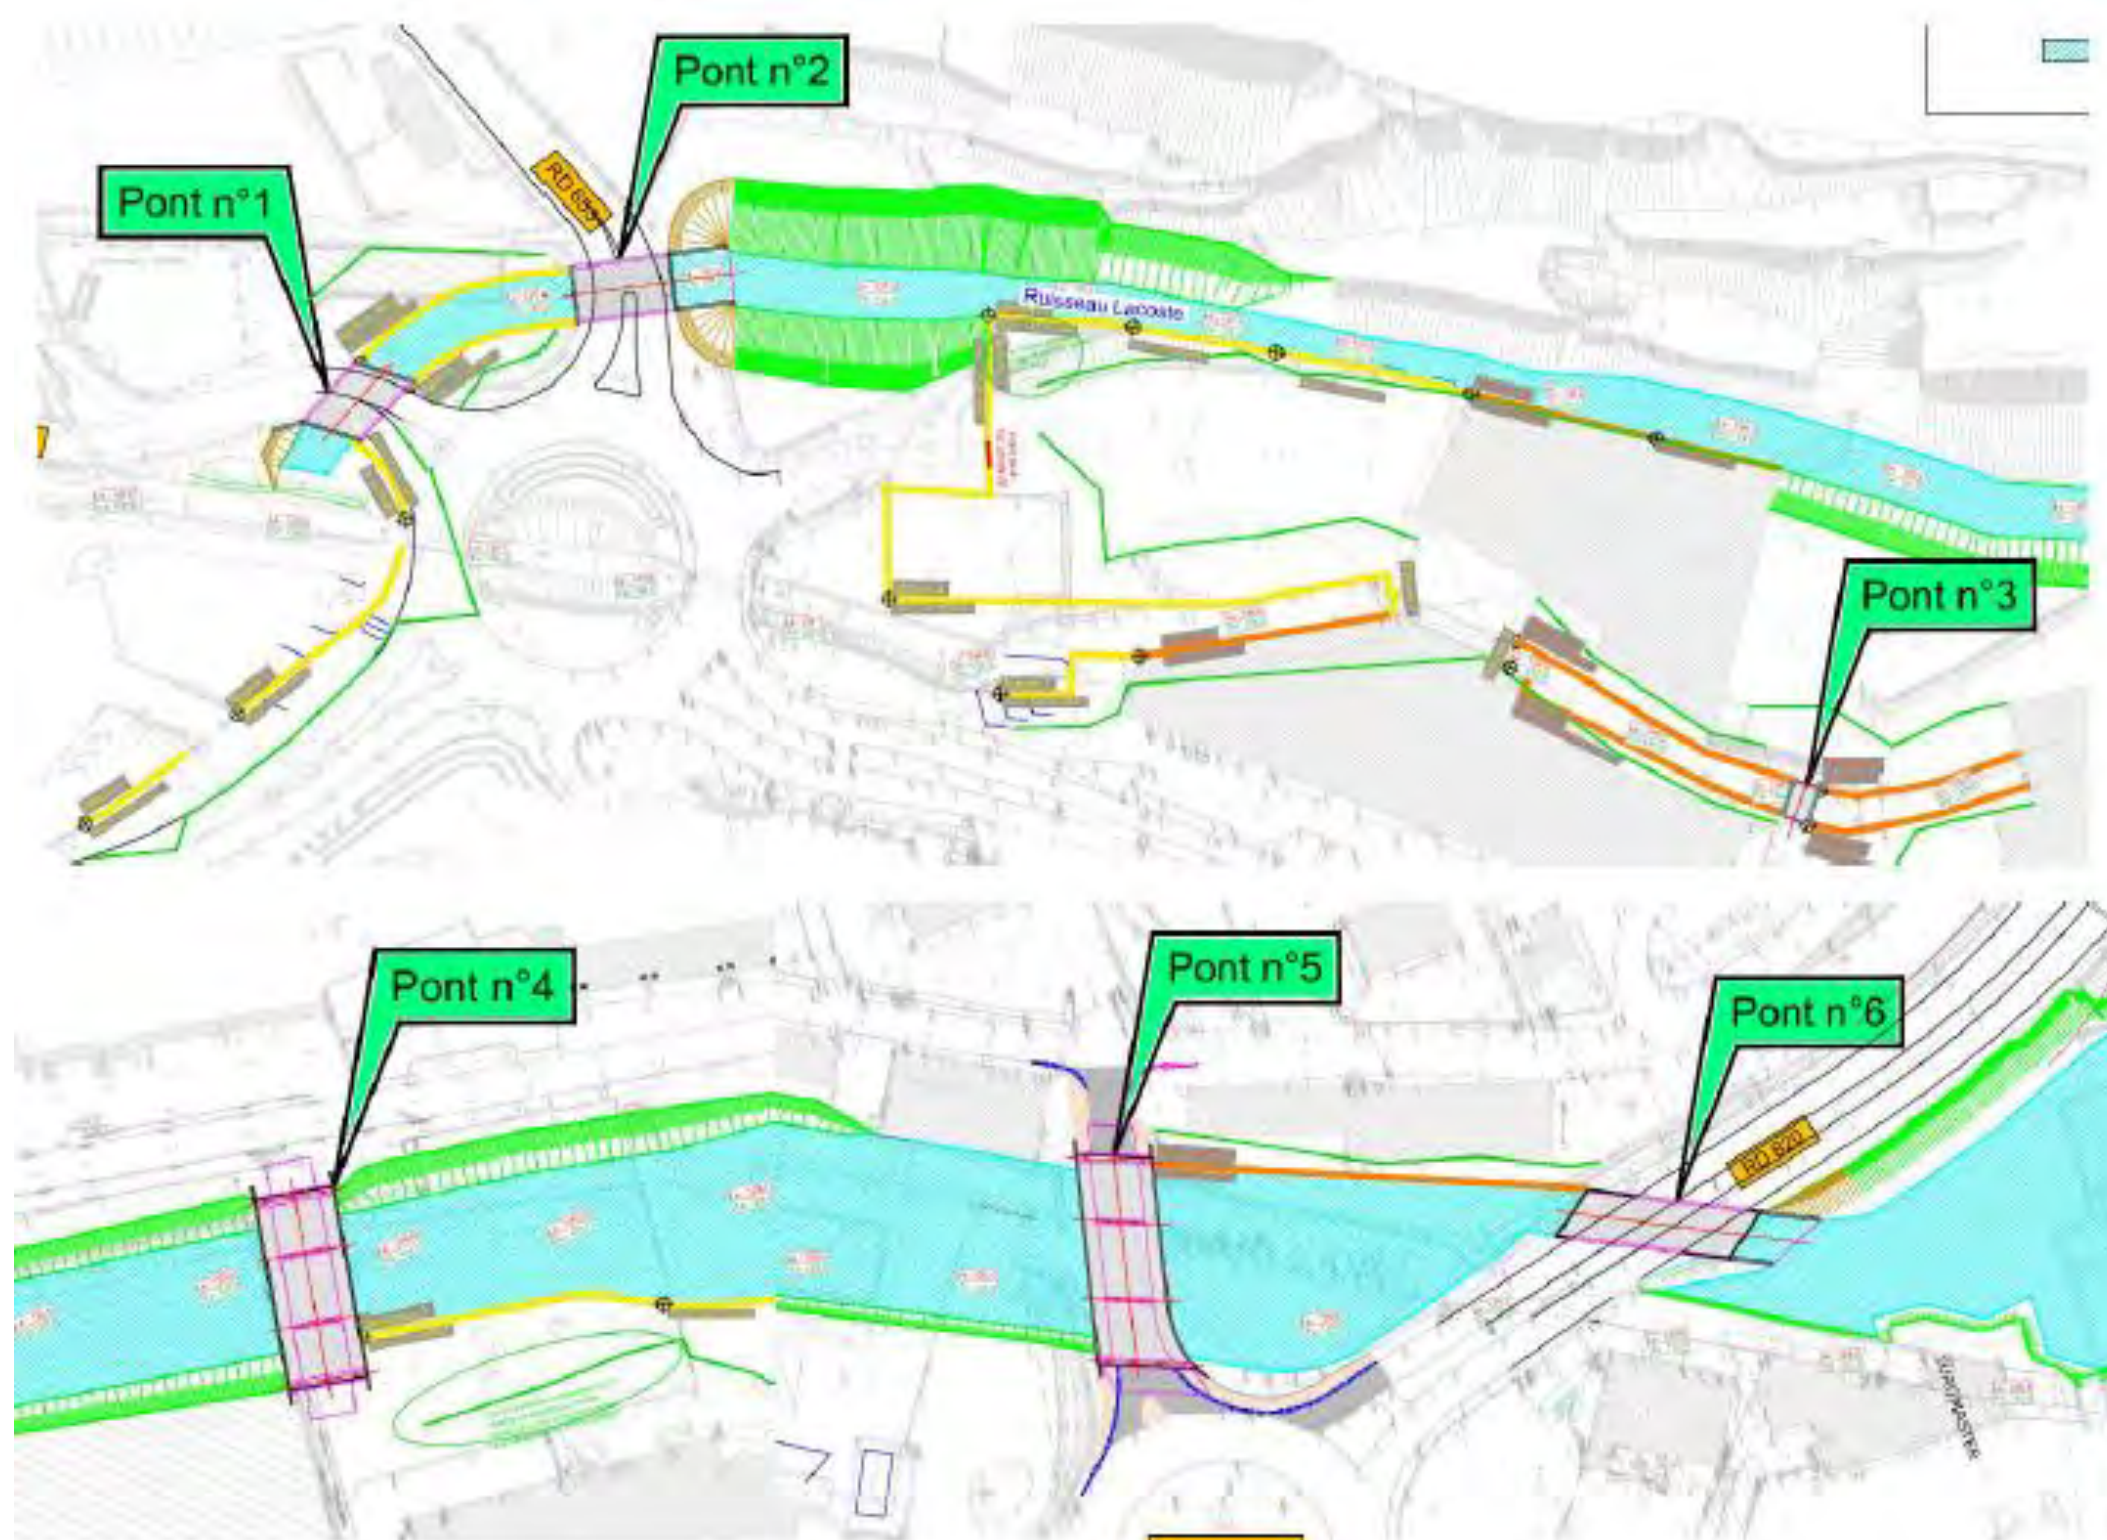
Plan des 6 ouvrages d'art de franchissement (Source : PRO)
